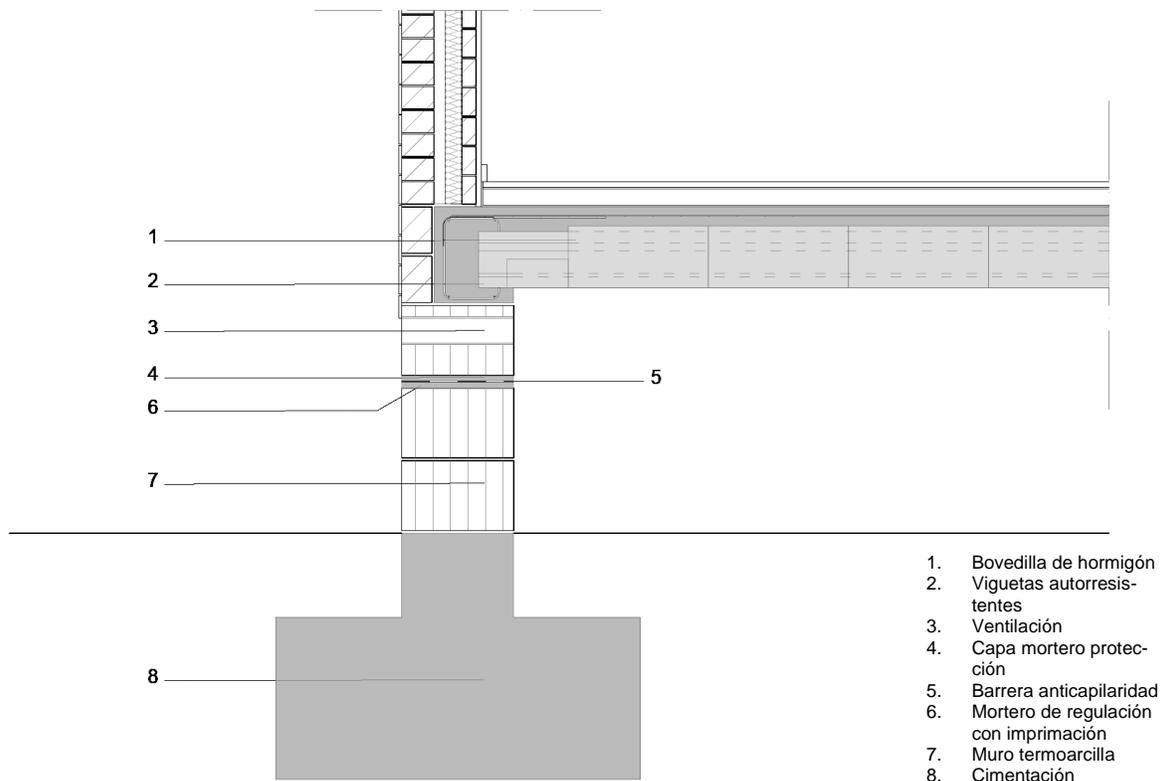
Detalle apoyo en muro termoarcilla con barrera anticapilaridad.
